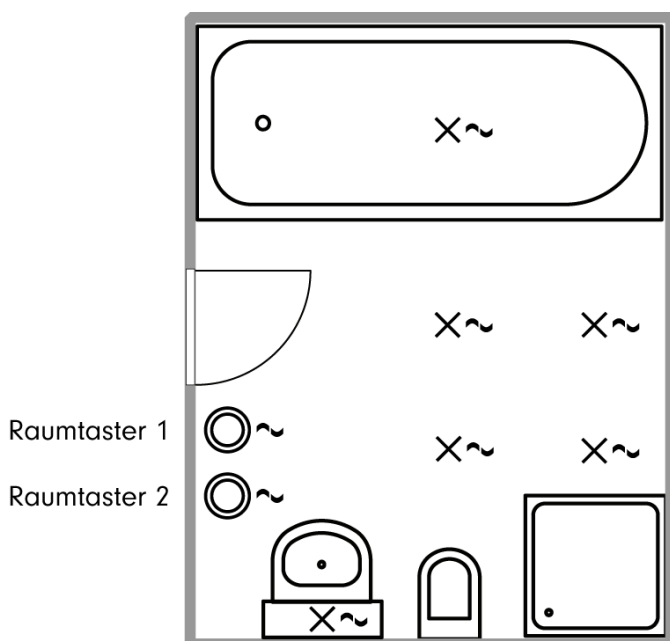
Raumplan Badezimmer mit zwei Raumtastern
